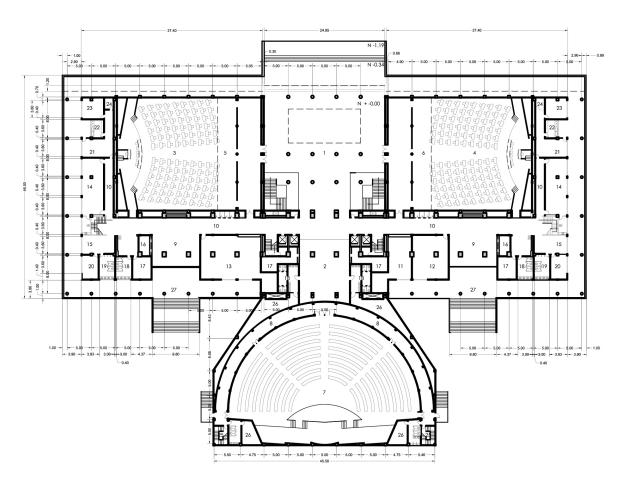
Planta baja N= 00 (Autoría propia, 2006).
